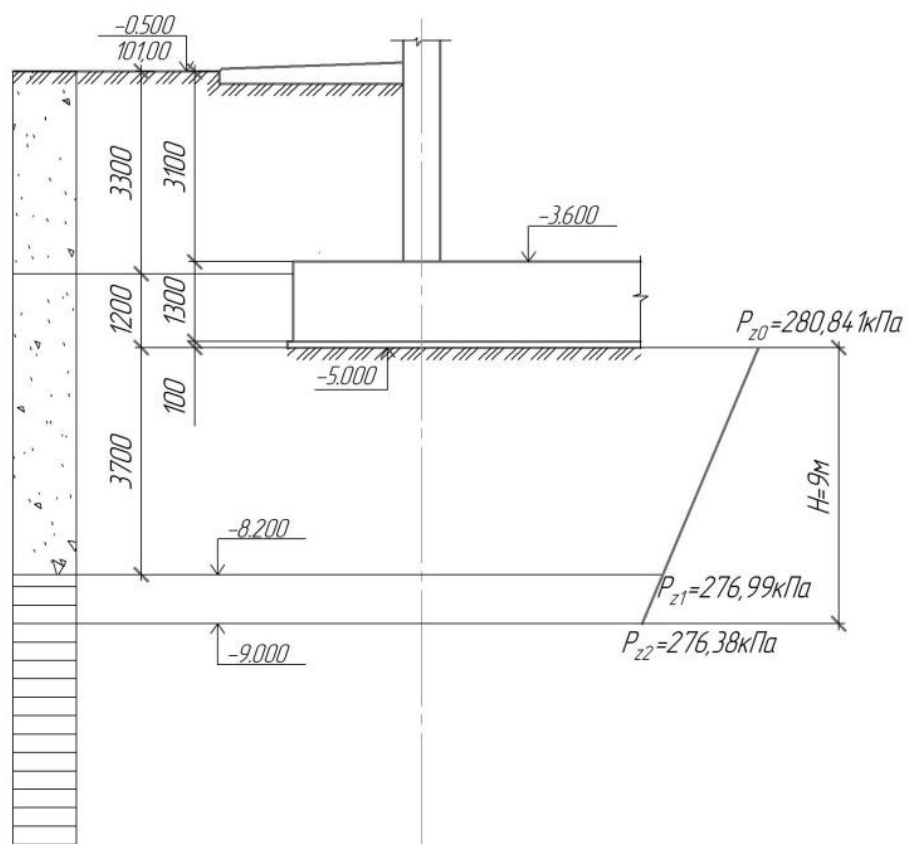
Схема к определению конечной осадки фундаментной плиты
